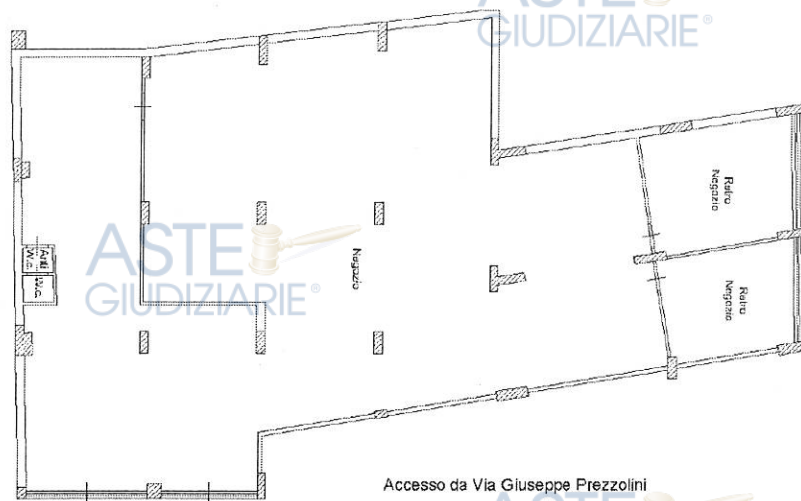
Planimetria catastale n. T381408 del 25/01/2024
